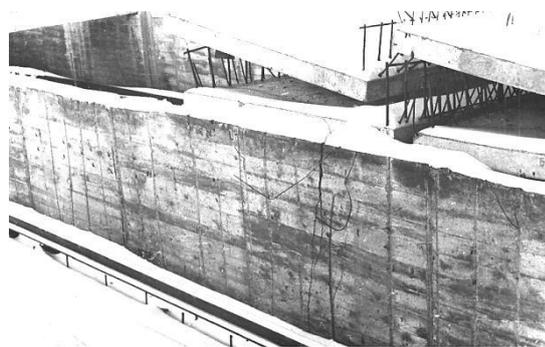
Раскрытие трещин в стенке пропарочной камеры завода керамзитобетонных панелей БСИ ТНХК
